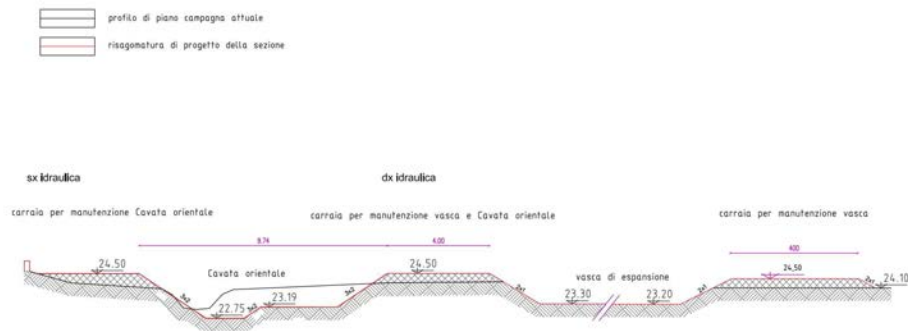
Sezioni tipologiche di progetto della Cassa di espansione a servizio della Cavata Orientale
